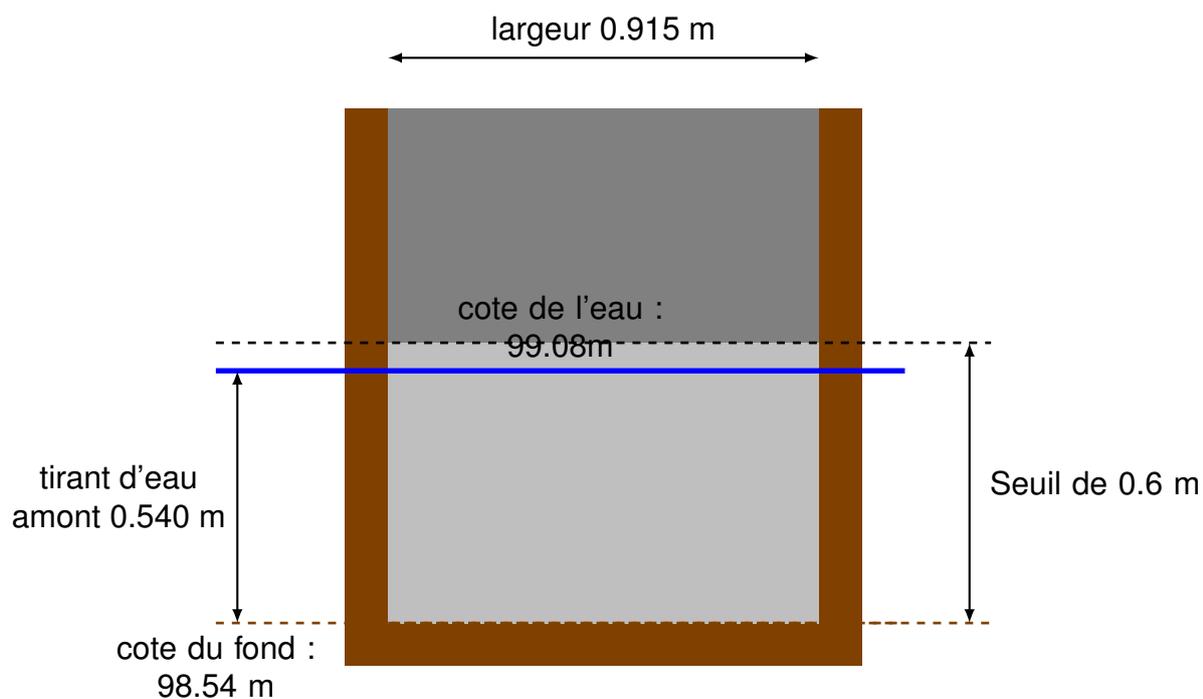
Coupe transversale de la vanne de décharge du canal du roi
